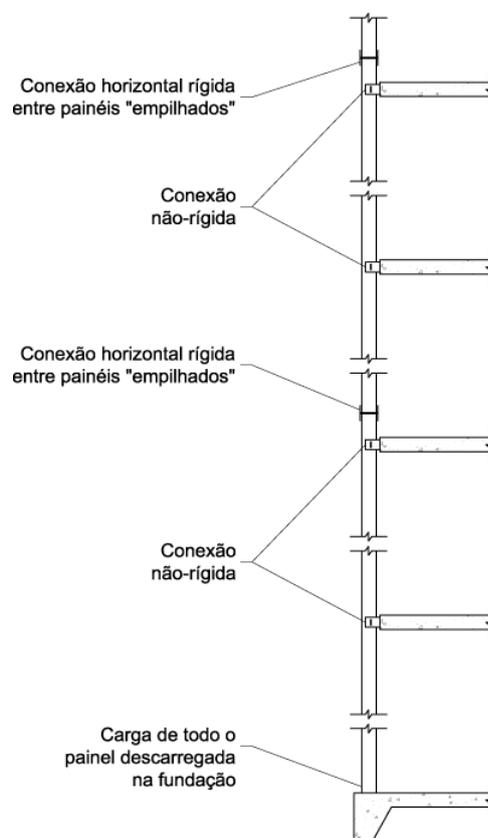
Painel dividido verticalmente, utilizando conexões não-rígidas em todos os pavimentos
